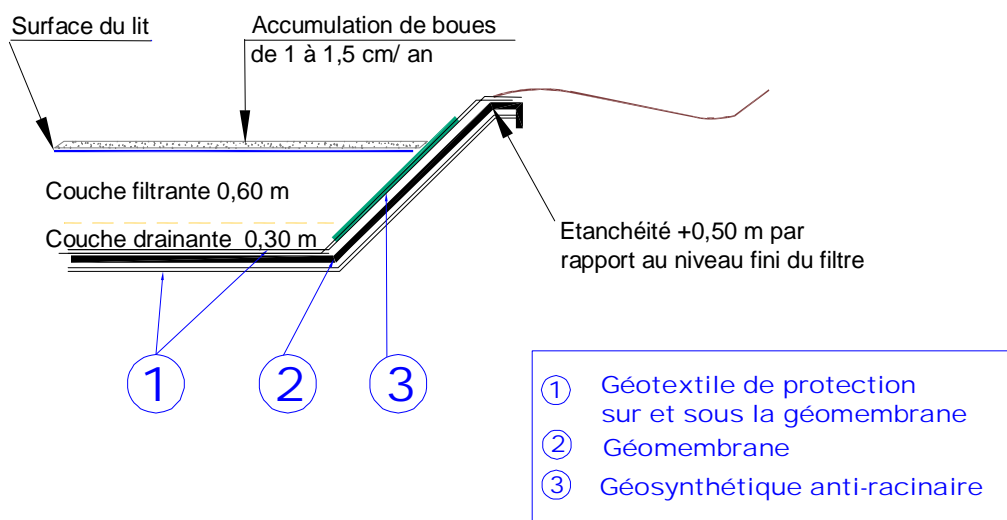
Profil filtre planté 1<sup>er</sup> étage – Coupe sur DEG en fond et en talus
